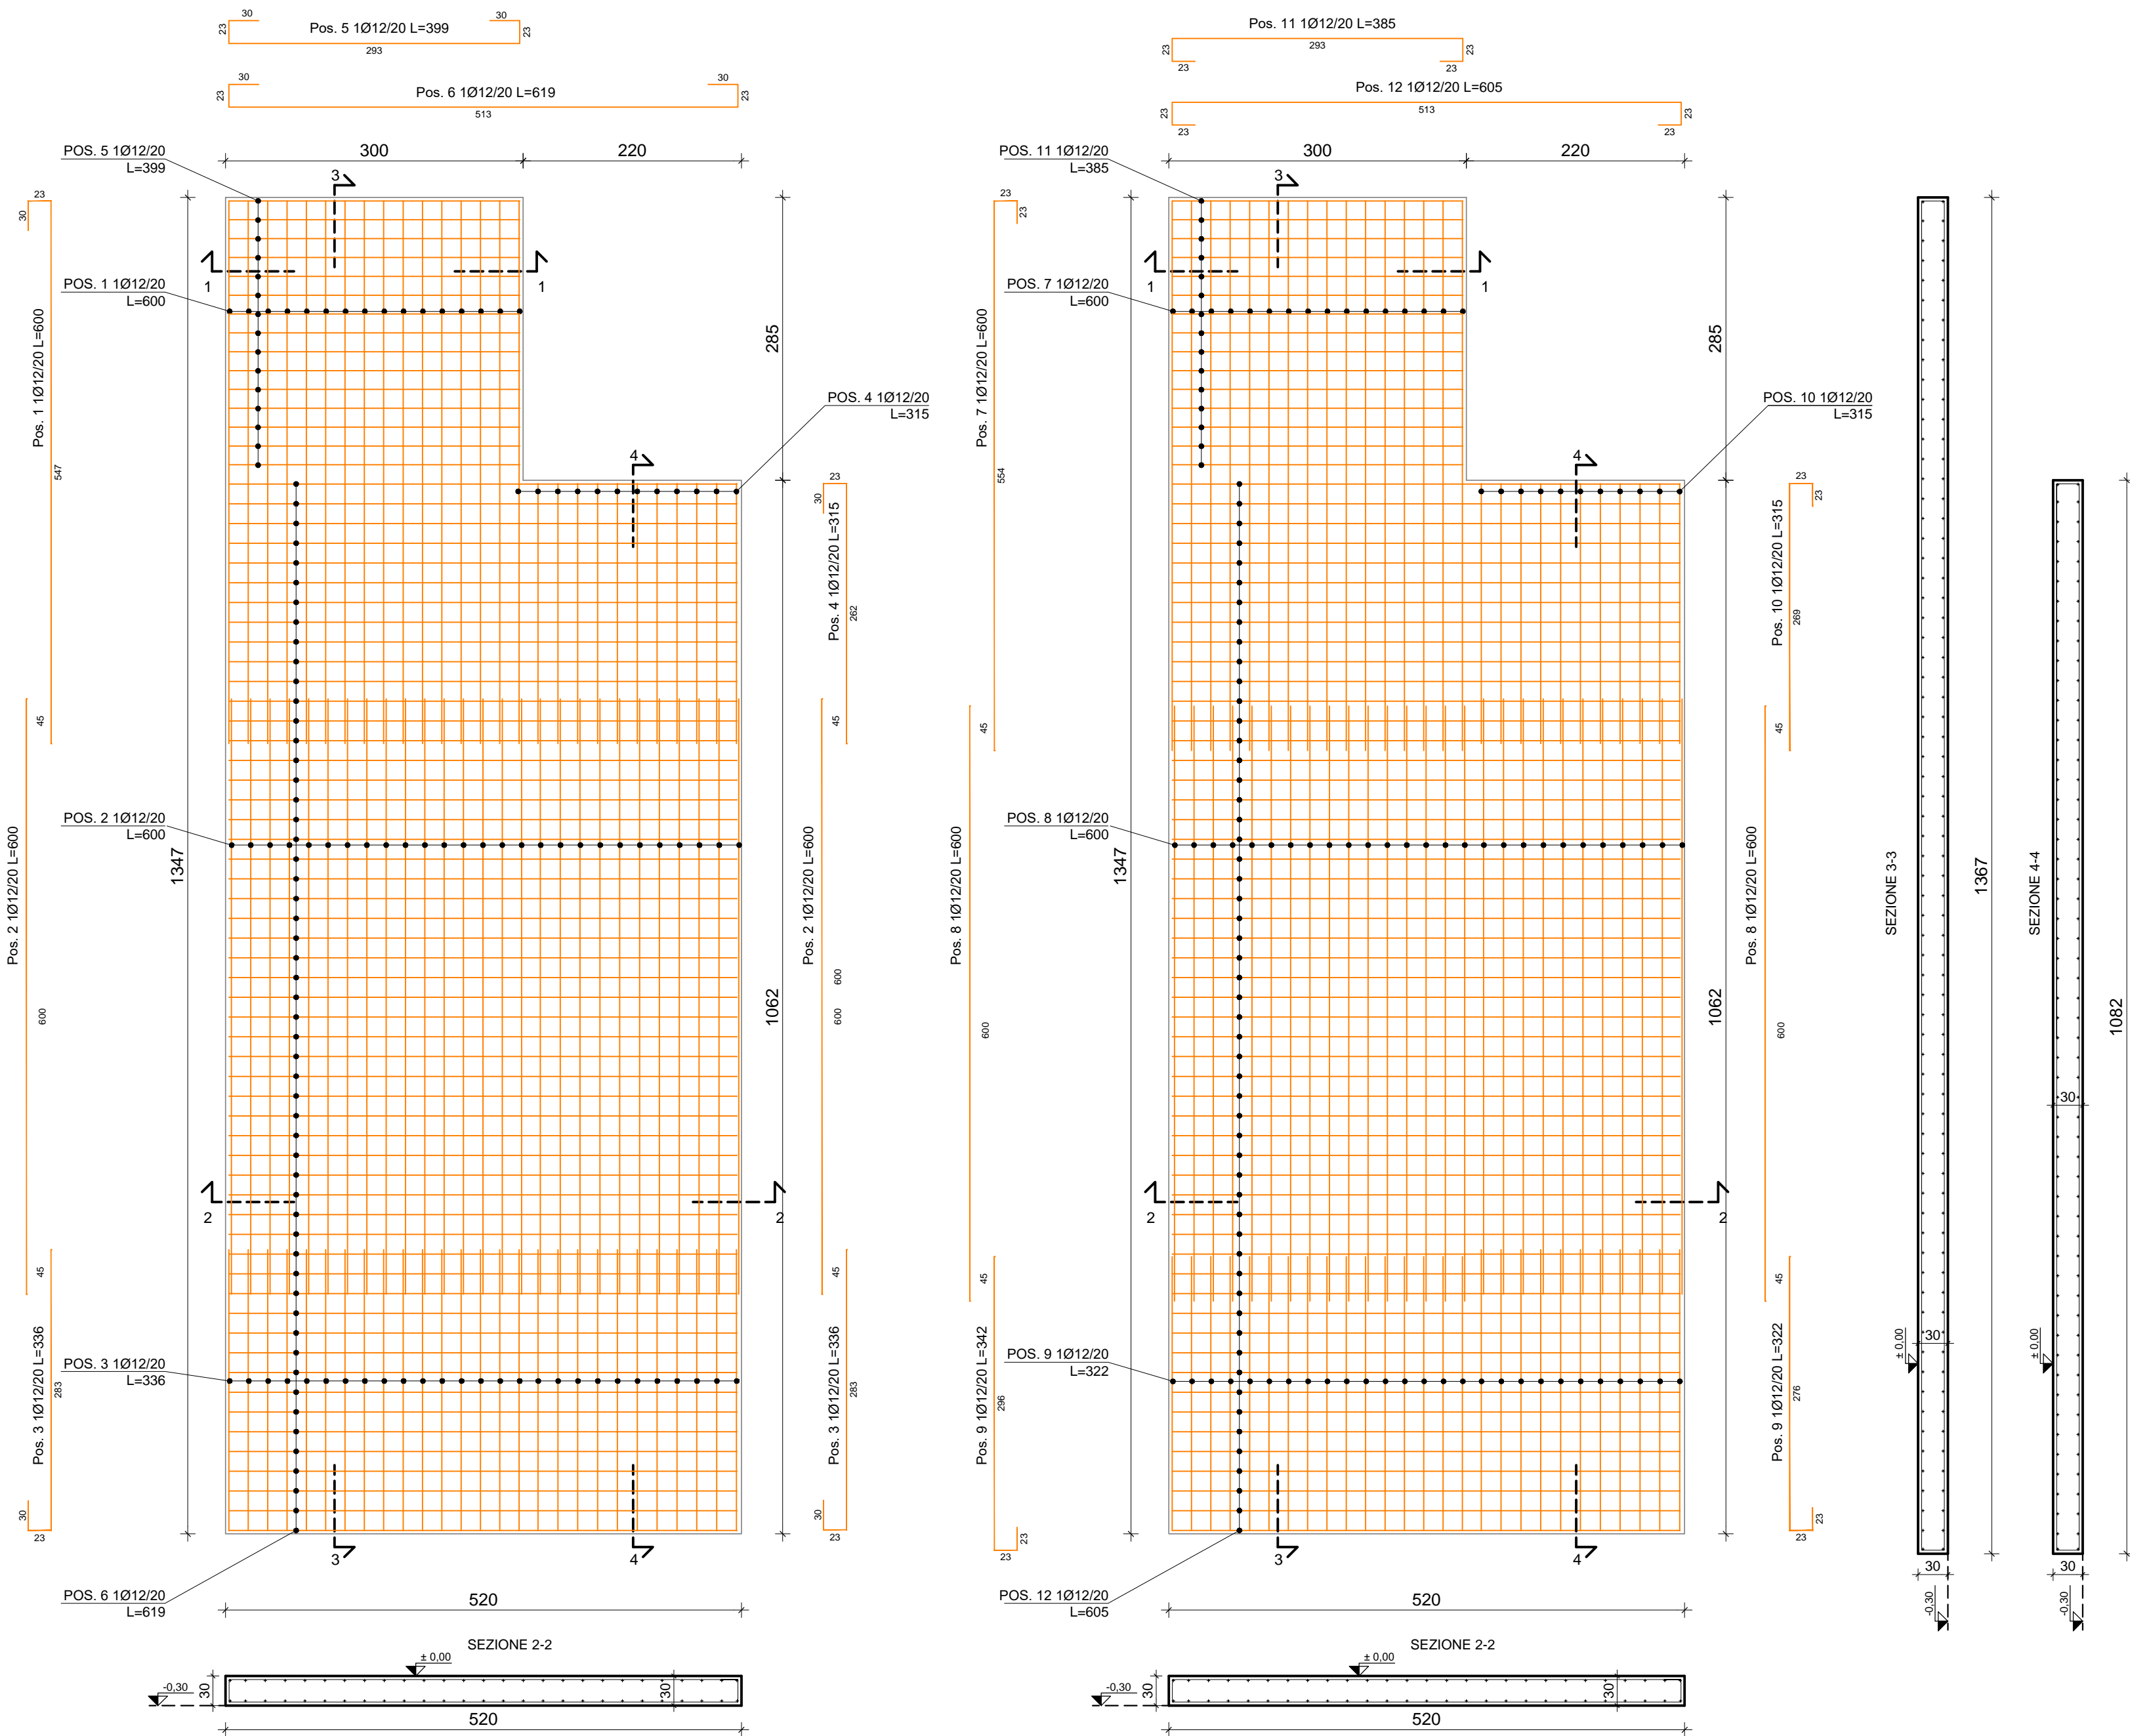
PLATEA DI FONDAZIONE DEPOSITI - ARMATURE scala 1:50
